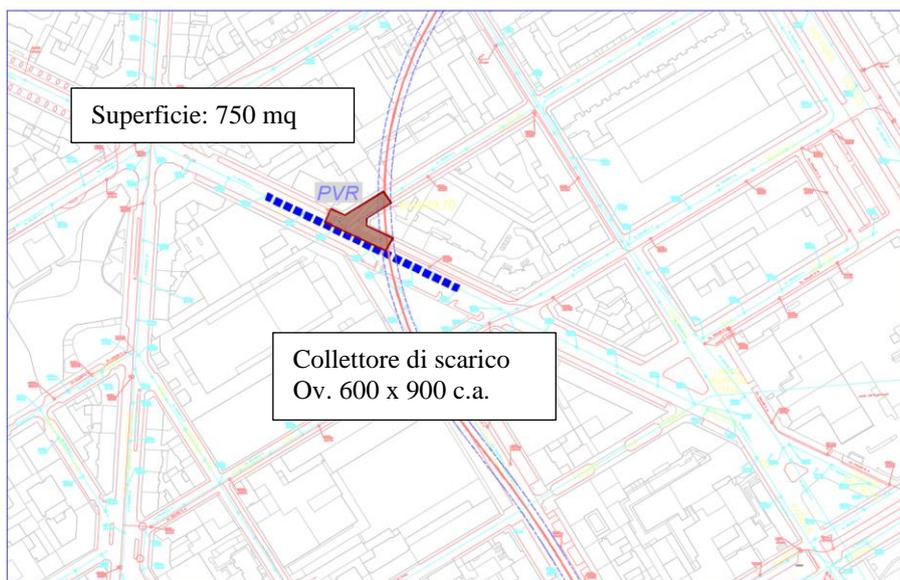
Aree di cantiere – Pozzo PVR – FASE UNICA
